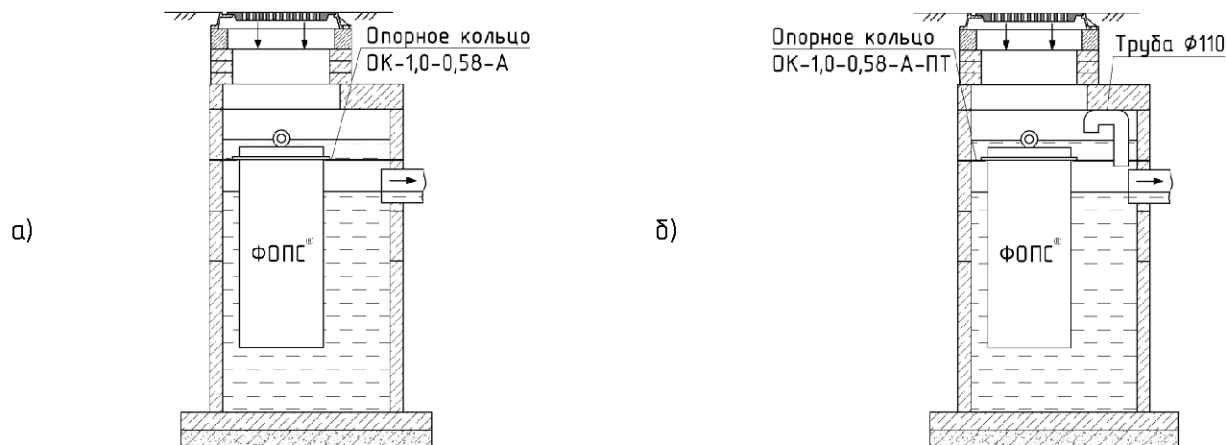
/2. Установка фильтра ФОПС® ниже плиты перекрытия:
